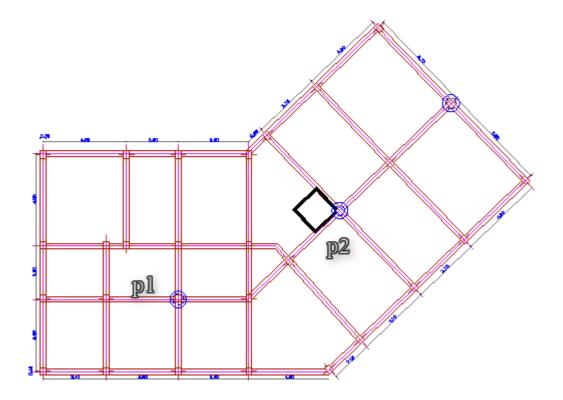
vue en plan des deux poteaux pour la descente de charges.
